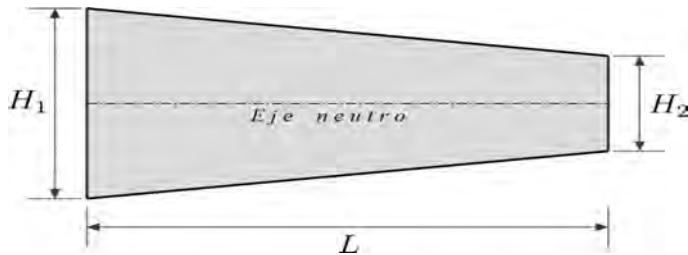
Viga ahusada. Elaboración: Jaime Retama Velasco.
